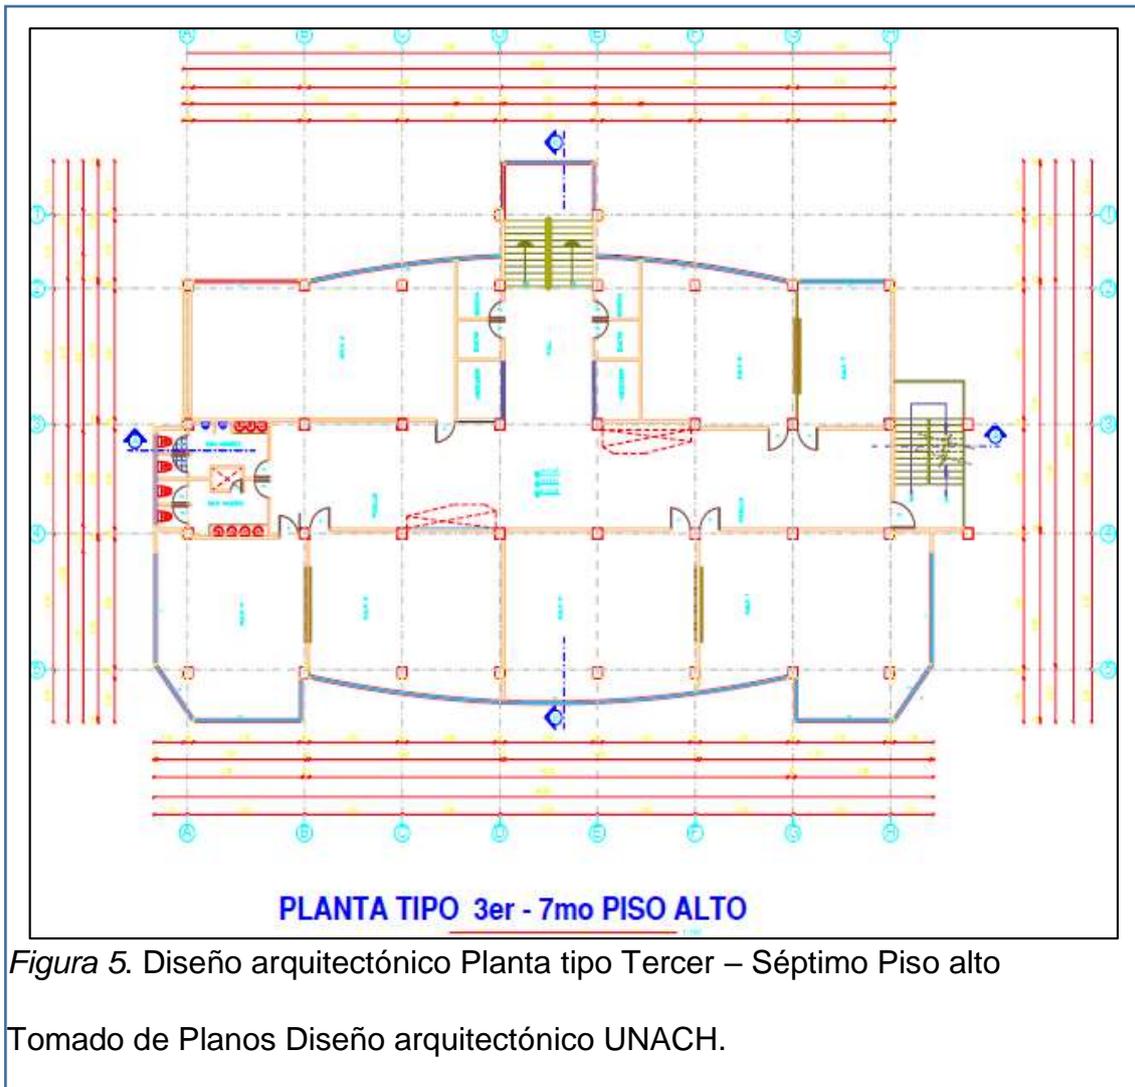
Diseño arquitectónico Planta tipo Tercer – Séptimo Piso alto
